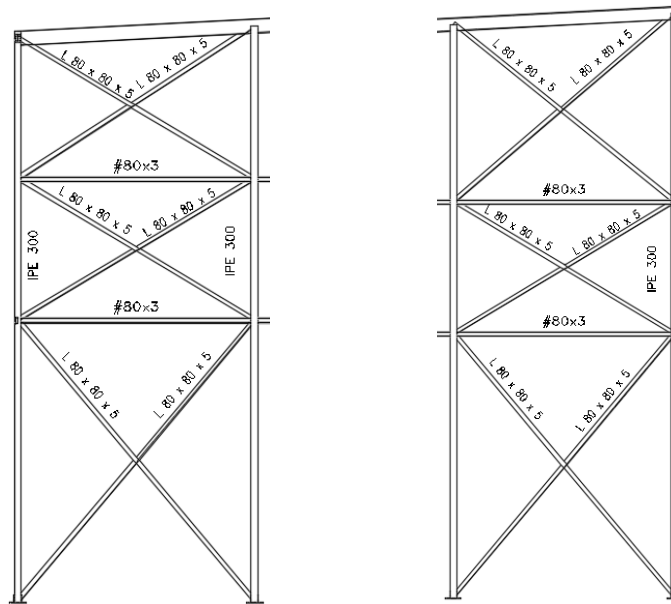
Arriostramiento Pórtico de Fachada N. (Fuente: Cype 3D)
